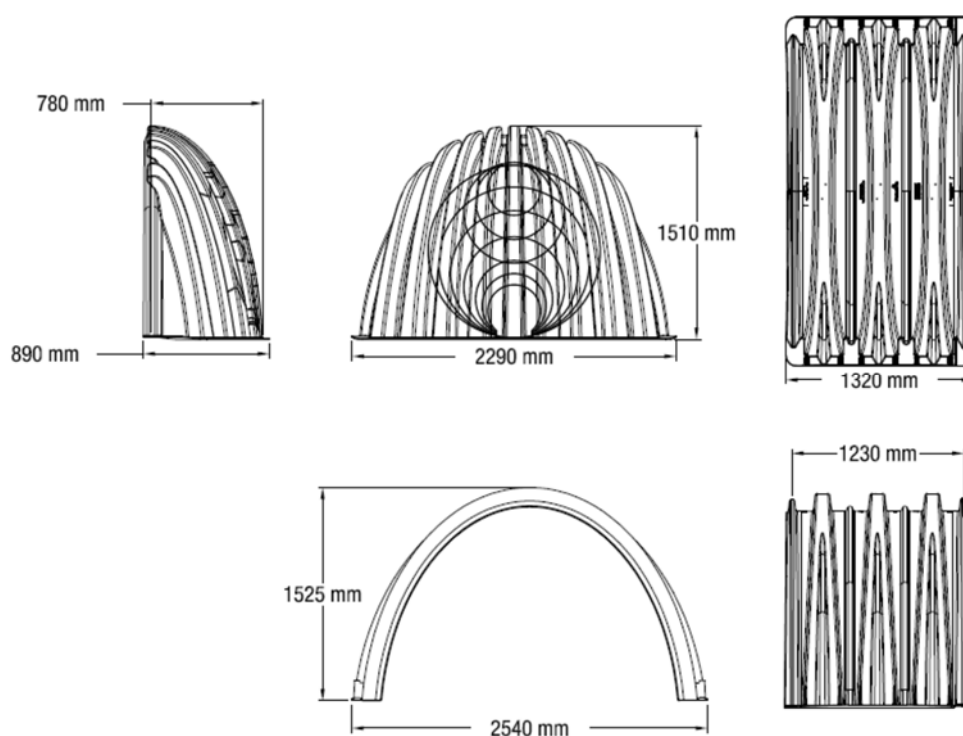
Dimensions de la chambre STORMTECH MC4500 (tolérance : 3 %)
